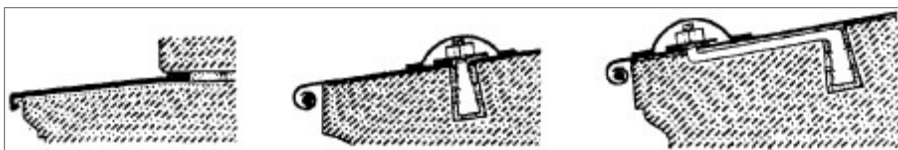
Befestigung mittels Flacheisen⁶⁸
